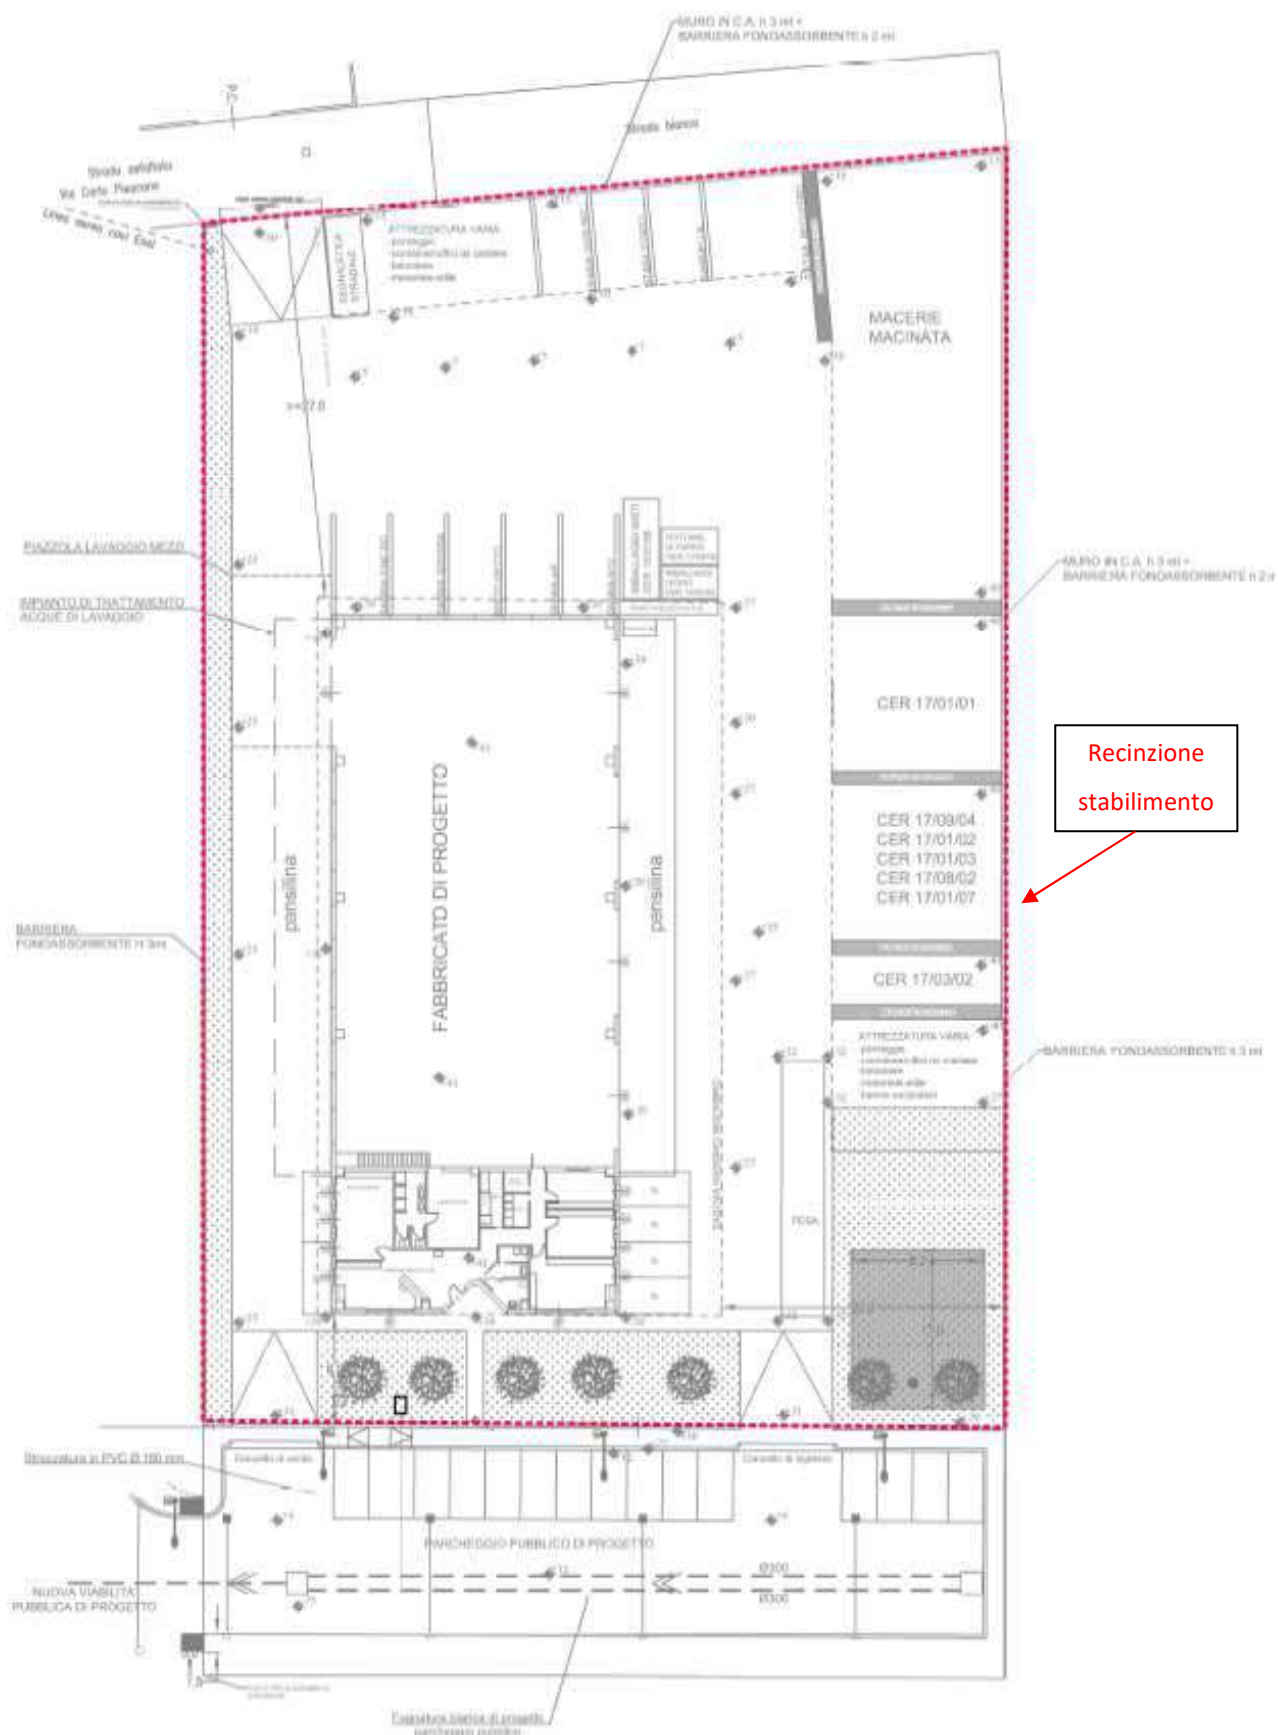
Planimetria di progetto degli interventi con evidenza della recinzione dello stabilimento
